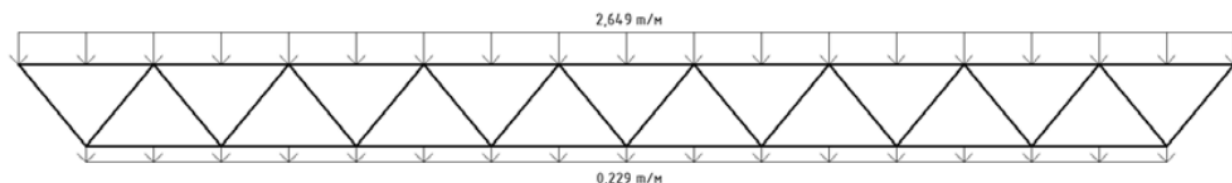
Схема приложения нагрузок к поясам фермы
